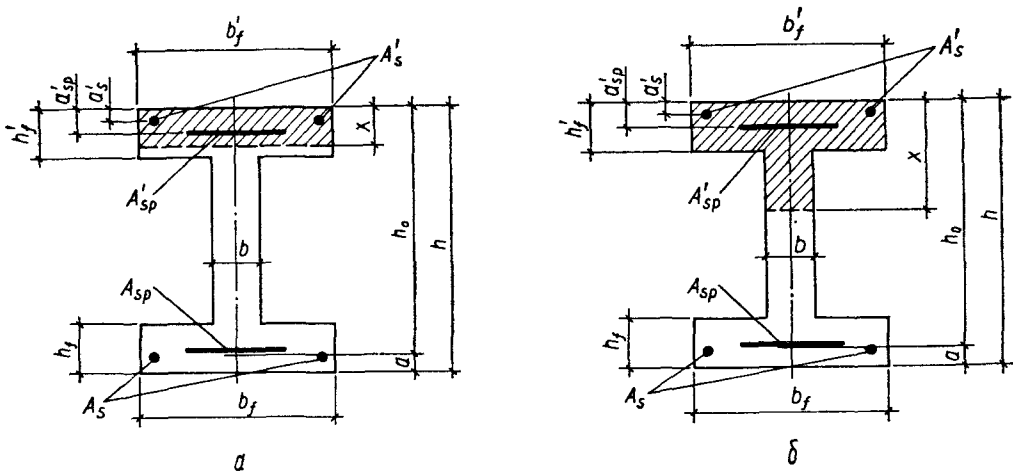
Форма сжатой зоны в двутавровом поперечном сечении железобетонного элемента при расположении границы сжатой зоны:
